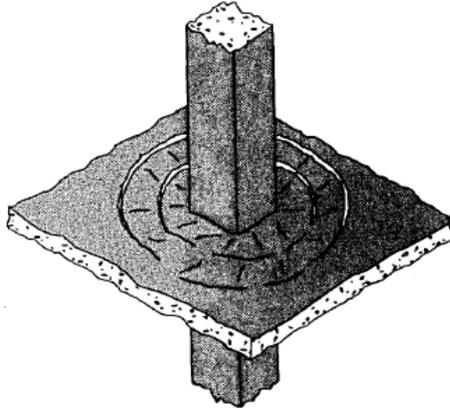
FISURAS POR PUNZONAMIENTO
